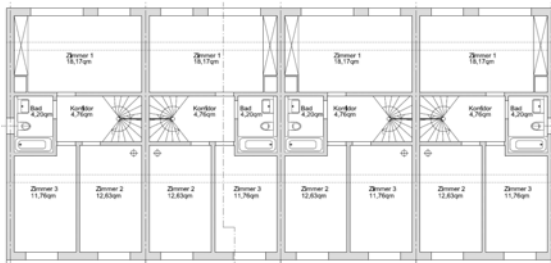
Grundriss des MFH's mit insgesamt vier Geschossen, wobei die oberen drei Etagen aktiv beheizt werden.
